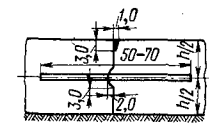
Конструкция рабочего шва коробления (размеры даны в см)
